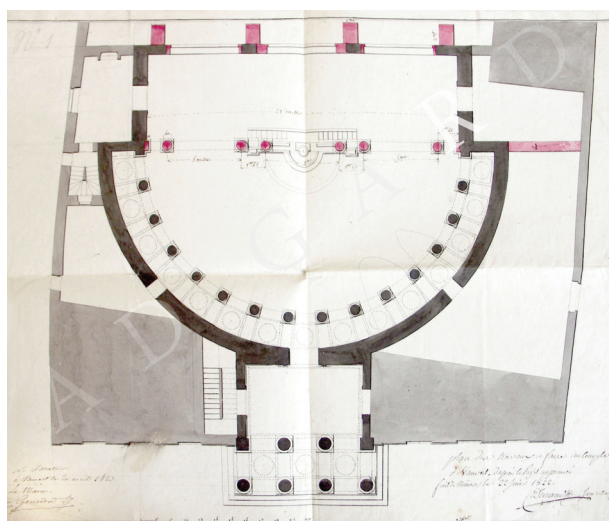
Vauvert (Gard), temple protestant ; plan des travaux à faire 22 juin 1822. J. Clier © AD Gard. 42 J 70.
